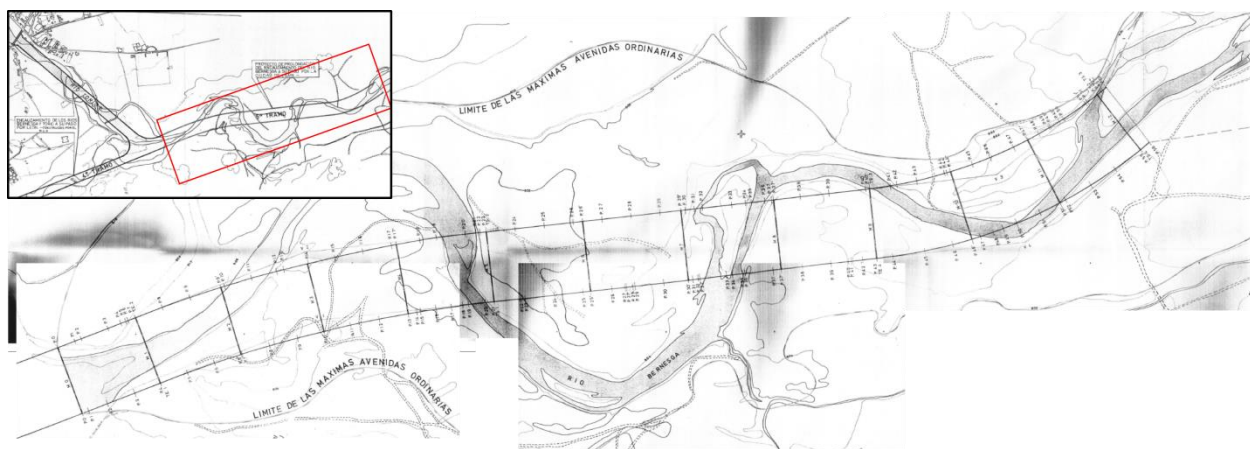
Plano de situación (rectángulo en rojo) y planta del proyecto de prolongación de la canalización del río Bernesga en León (Pérez Alfonso, 1975).
